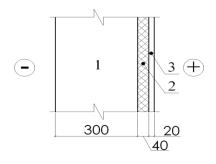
Конструктивная схема наружной стены для производственного здания с утеплителем толщиной 40 мм
